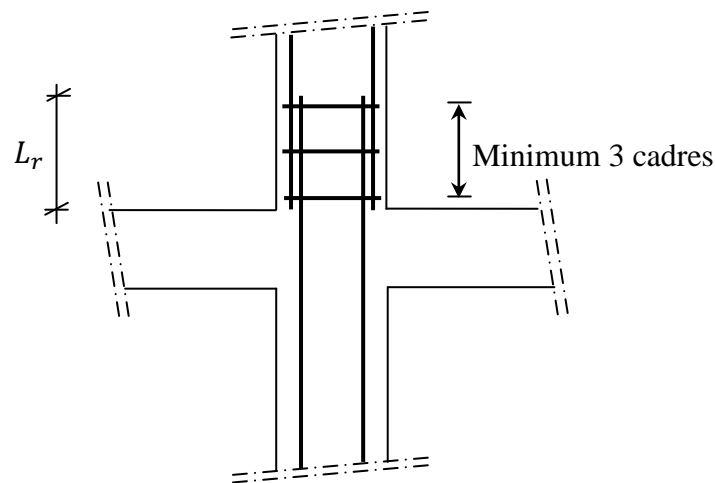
Les armatures transversales dans la zone de recouvrement
